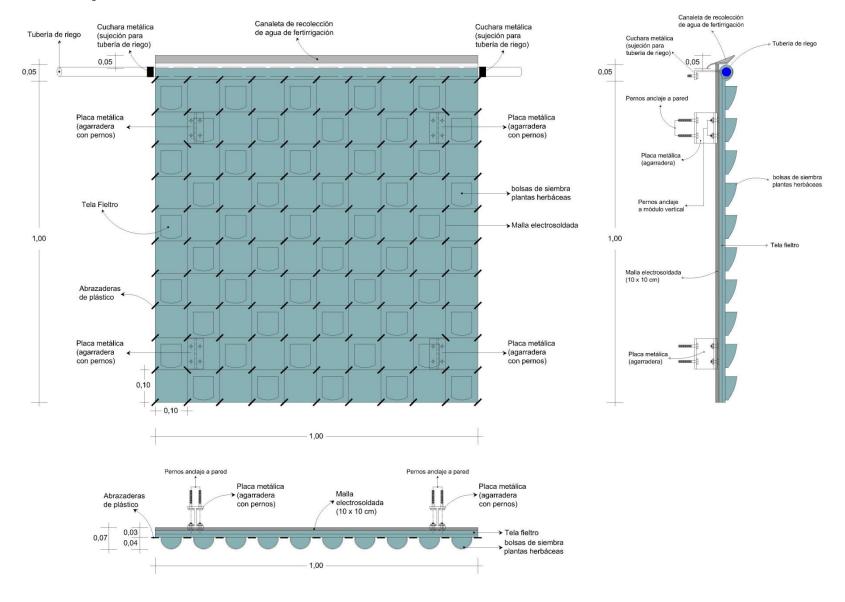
Detalle de panel modular (sin plantas herbáceas) .Fuente: Eduardo Rivadeneira
